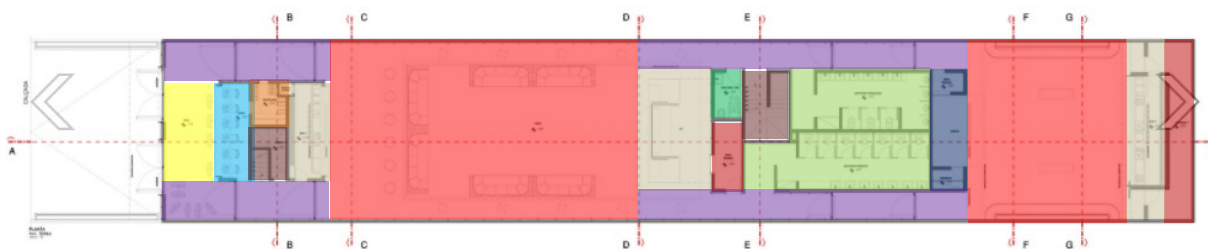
Planta do primeiro pavimento da Casa Noturna The Year Club. (Fonte: ARCHDAILY, 2016)
